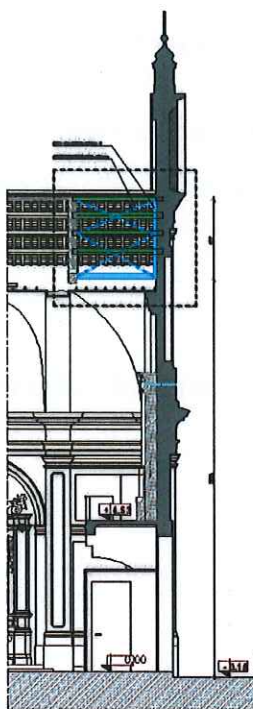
Stralcio prospetto laterale e prospetto di facciata – posizionamento delle catene
